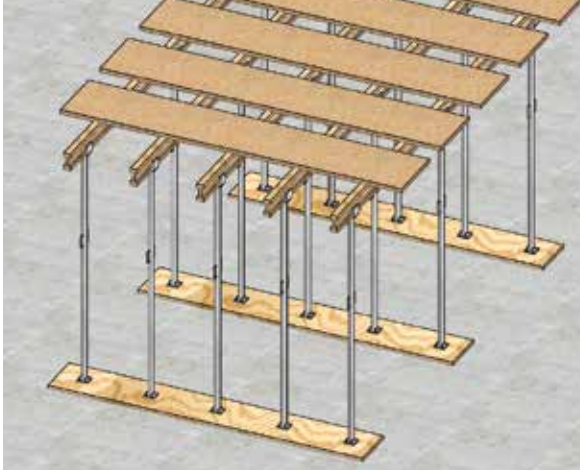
Pose et mise à niveau des planches ou bastaings
